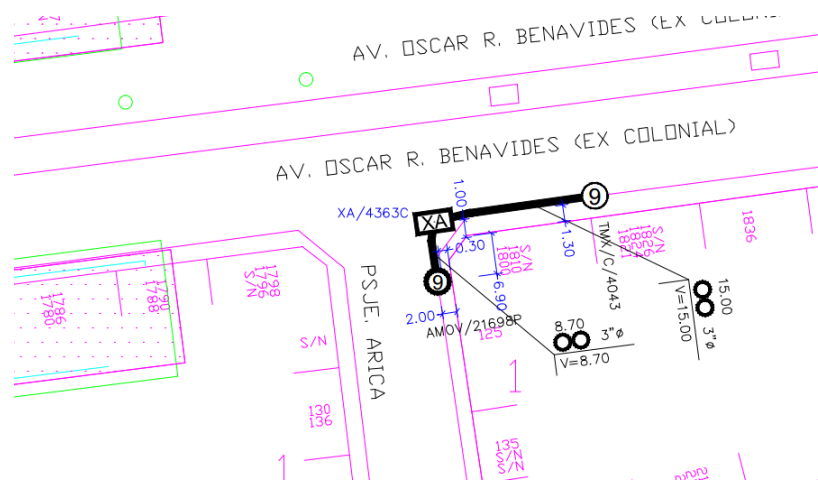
Esquema de Planteamiento de Liberación Adoptado Claro E2
